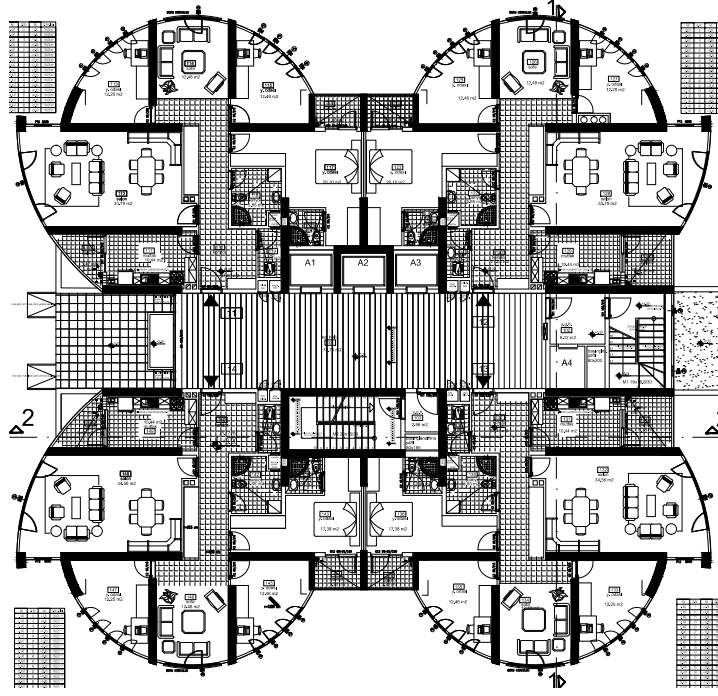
B Blok, 156 m2 büyüklüğünde daire planı
